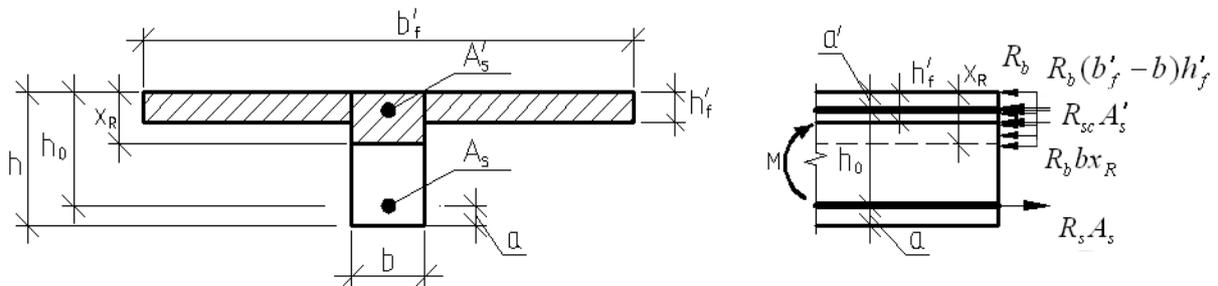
К расчету сжатой арматуры в элементах таврового профиля
